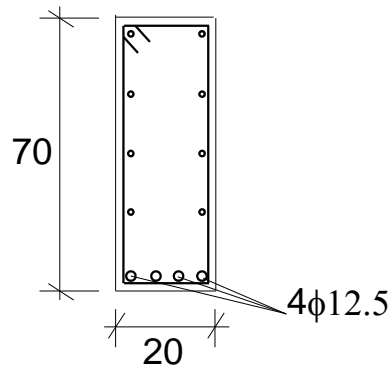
Seção Transversal da Viga – Momento Principal Positivo
